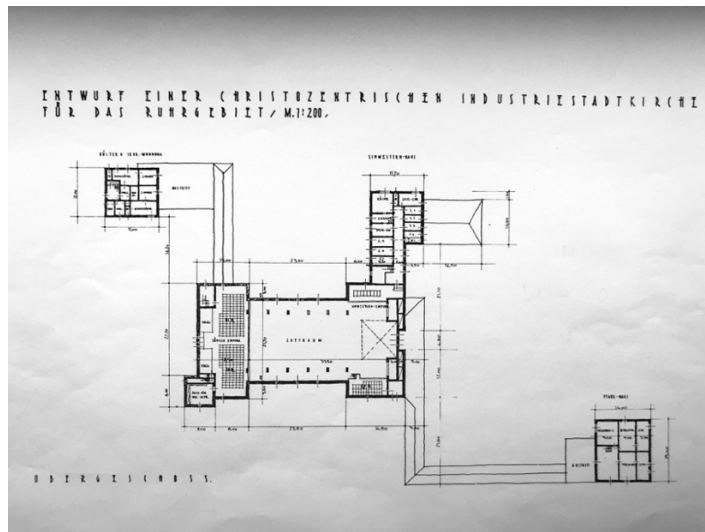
P. F. Schneider, Grundriss zum obigen „Entwurf einer christozentrischen IndustriestadtKirche“ (HASTK Bestand 1360, A 20)
